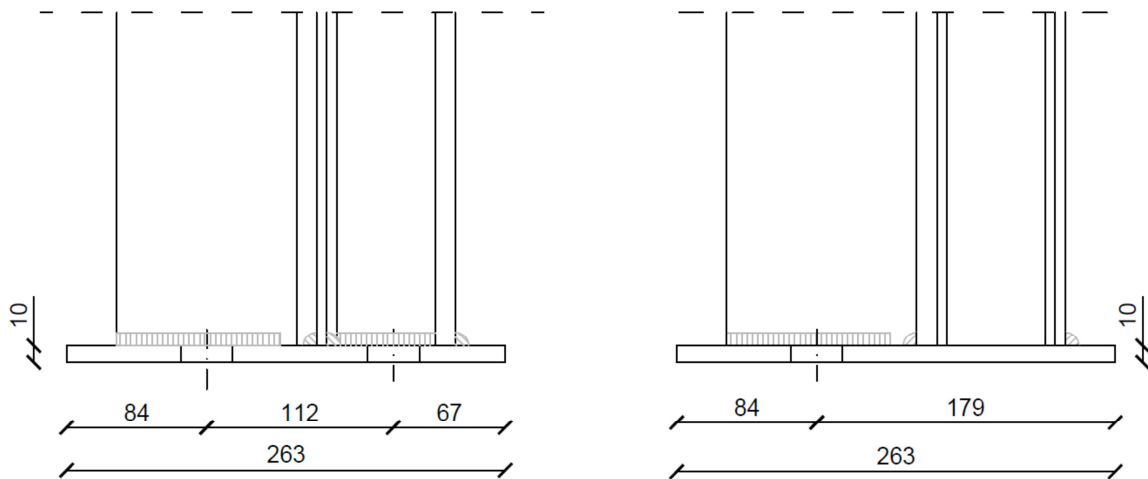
Sezioni A-A e B-B del collegamento a terra del montante ad L
